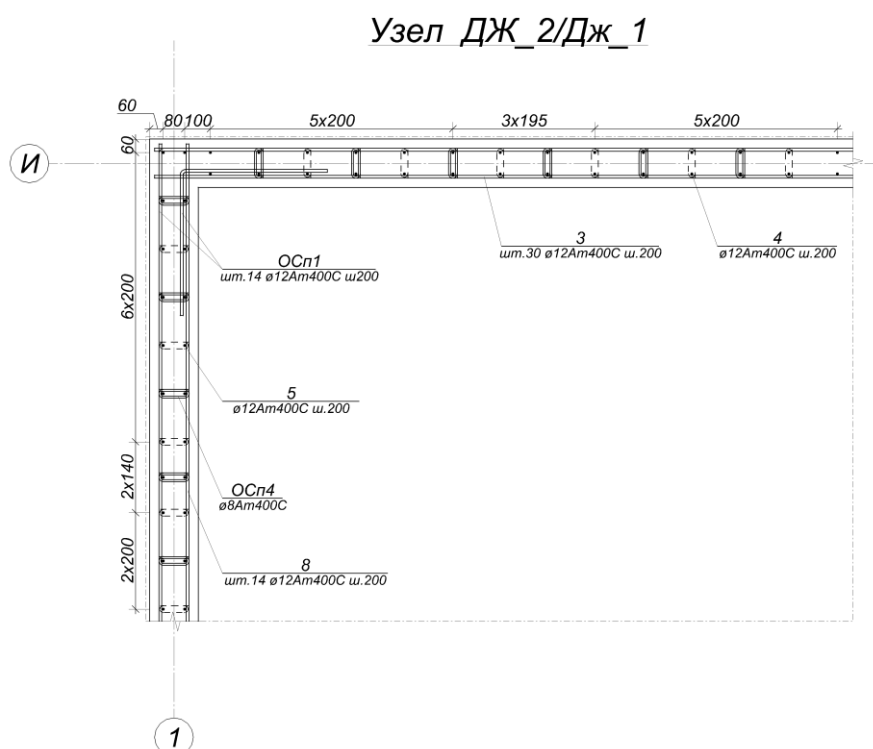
Узел армирования стен ДЖ_2/ДЖ_1
